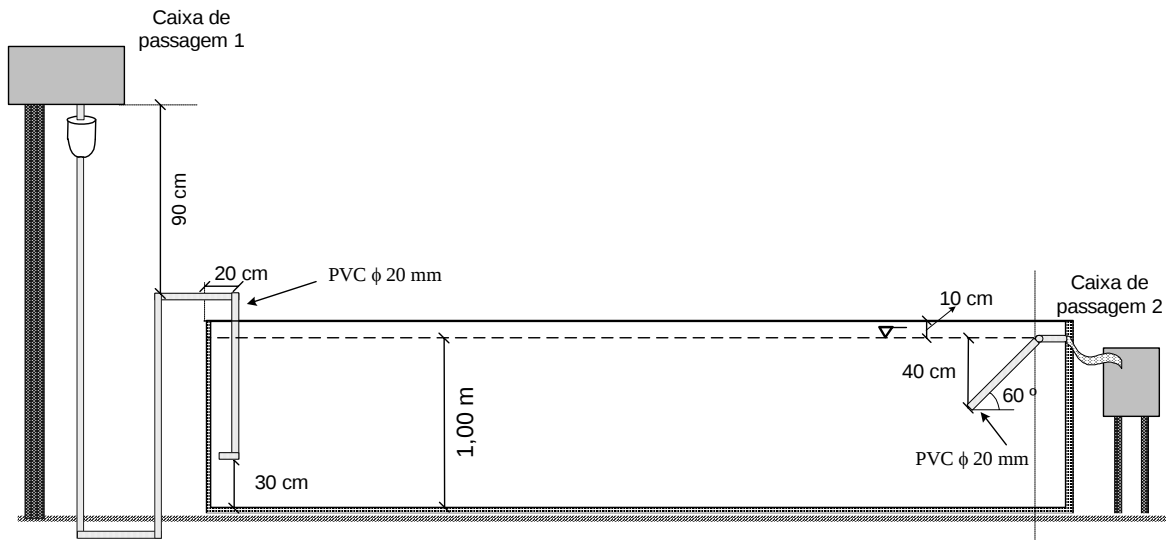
Lagoa 2 - corte BB da planta baixa
